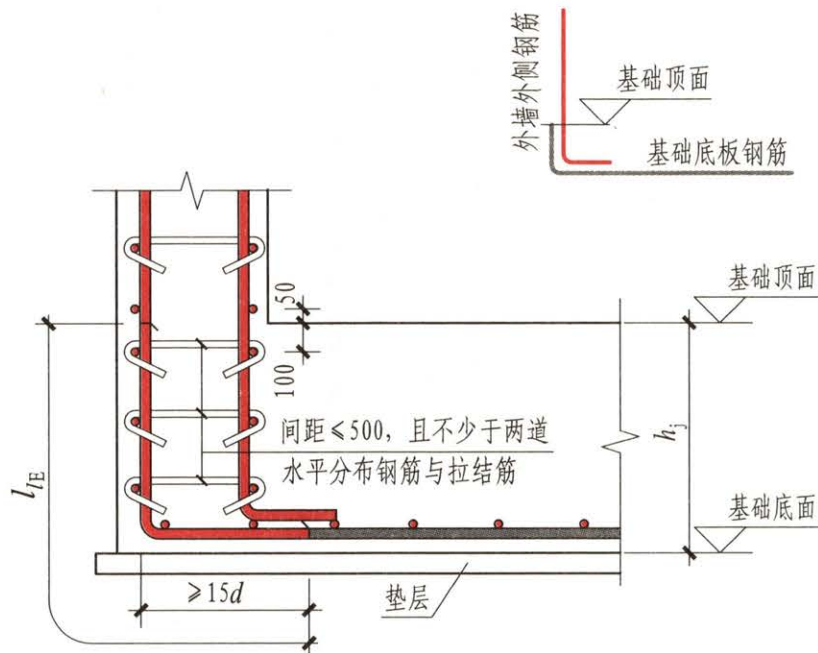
墙身插筋与基础底板钢筋搭接锚固构造
